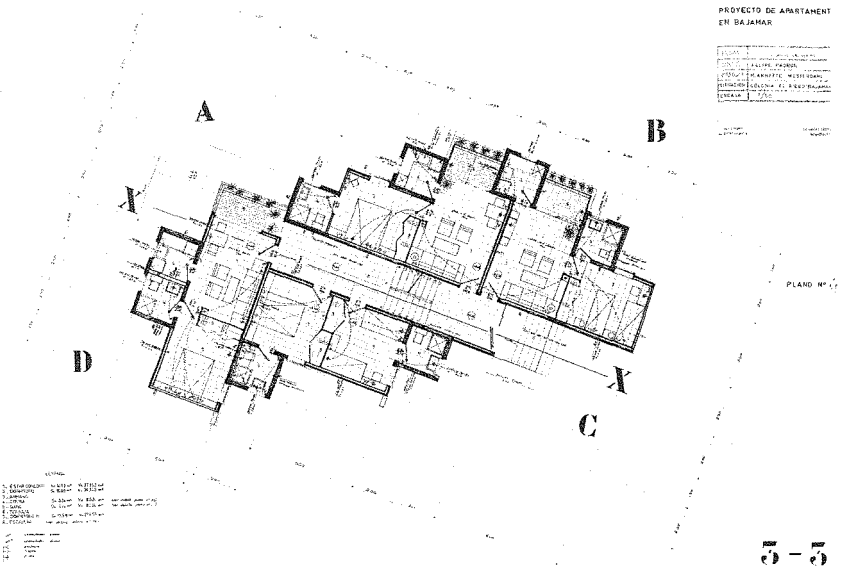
S. Fábregas, Plano n.º 4. Planta. Proyecto de apartamentos en Bajamar, Tenerife, (Archivo Fábregas).
